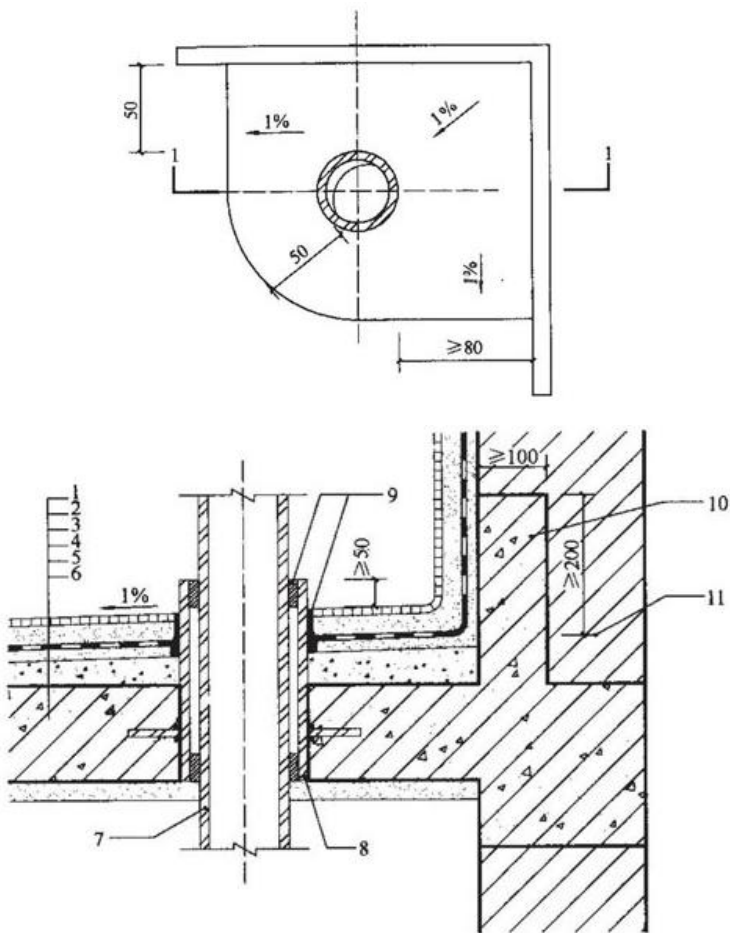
管道穿越楼板的防水构造及墙体混凝土翻边做法
